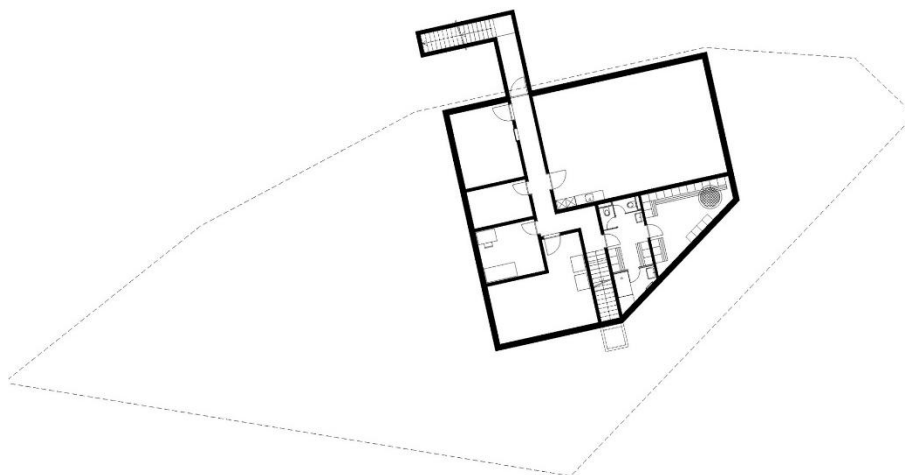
Ветеринарна клініка Masans / Domenig Architekten. План підвального поверху[3].
